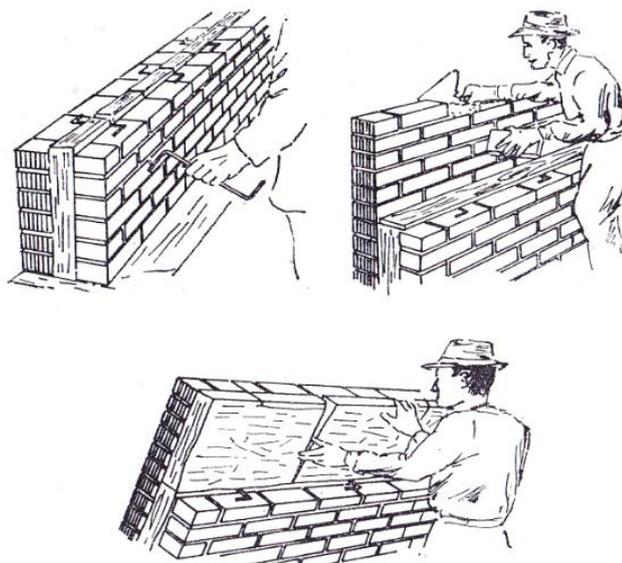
Método de incorporación de planchas de lana mineral durante la construcción de paredes de ladrillo con cámara de aire.
